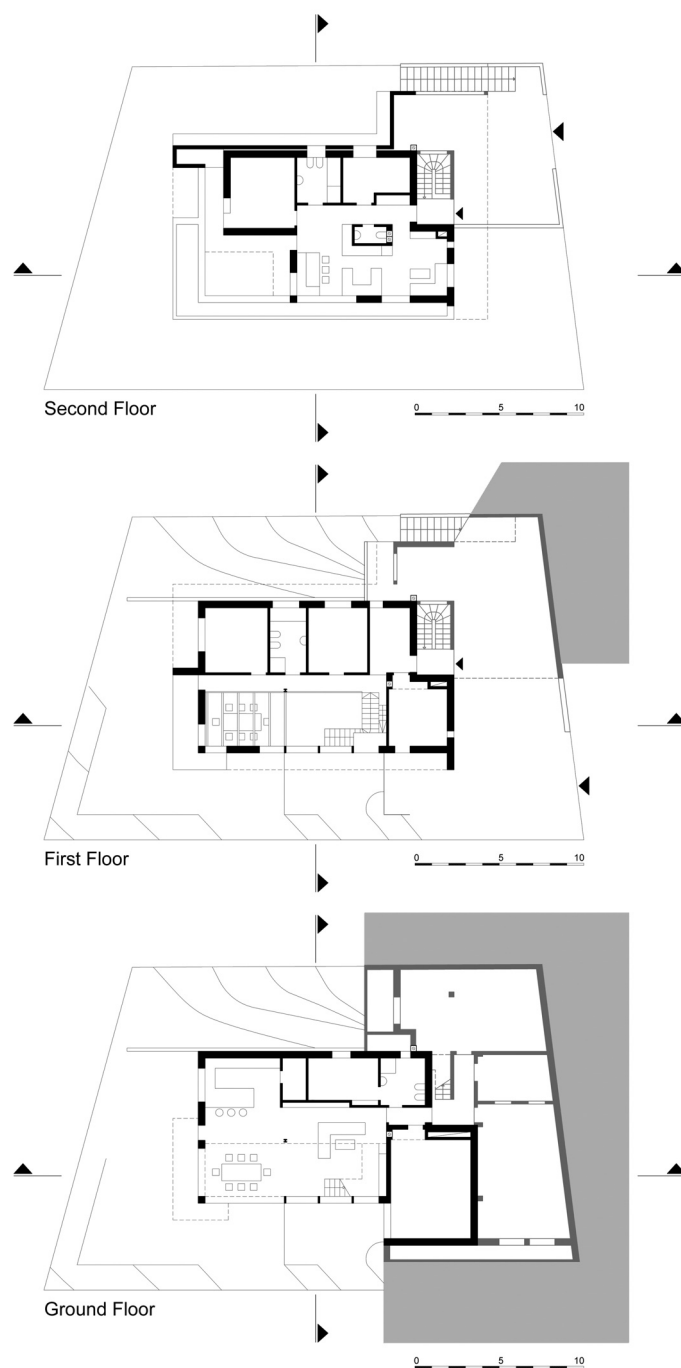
La pianta dei tre livelli dell'edificio.
